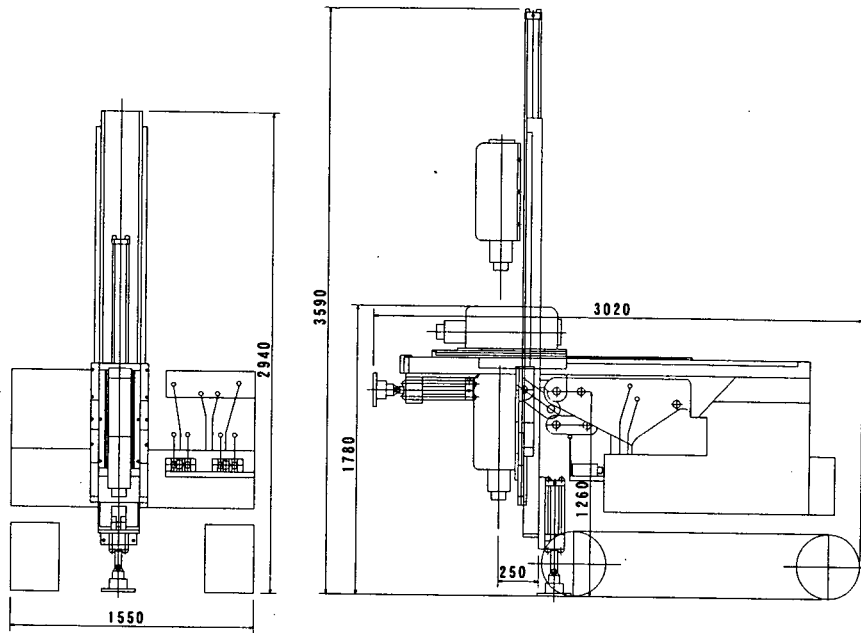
打撃工法の施工機械例 (小型ボーリングマシン)
